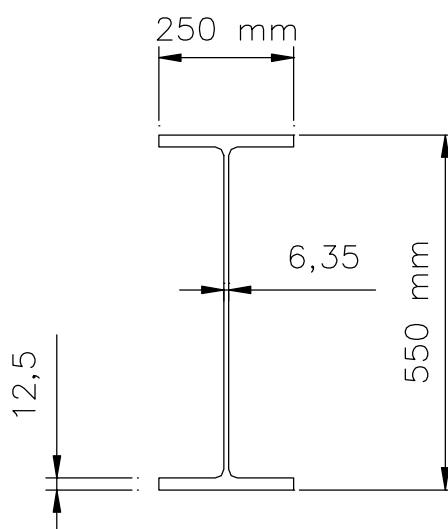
Seção transversal do perfil para viga de rolamento.
